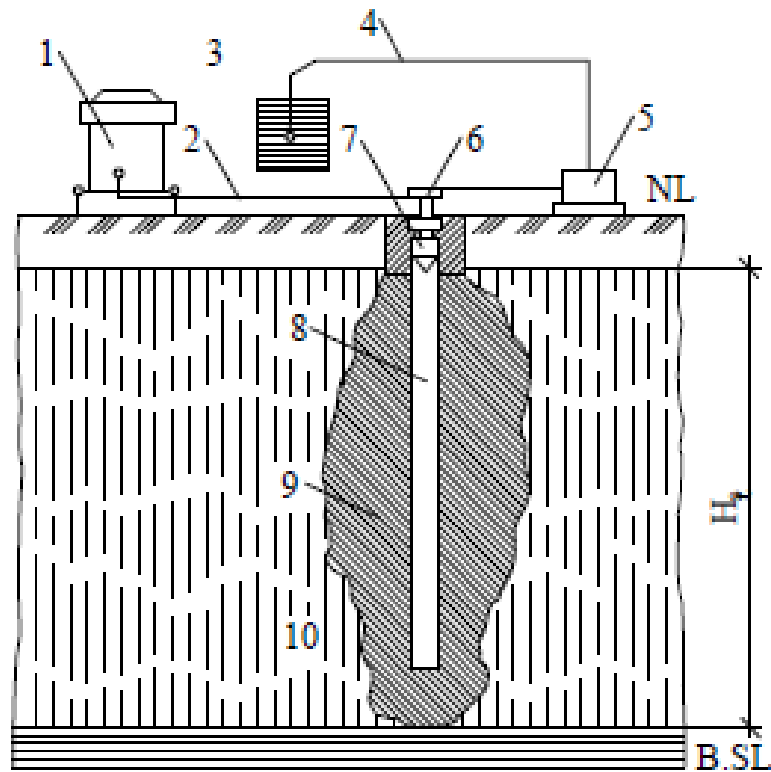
Схема термічного закріплення лесового ґрунту: 1 – компресор; 2 – трубопровід холодного повітря; 3 – місткість для пального; 4 – трубопровід для пального; 5 – насос для нагнітання пального; 6 – форсунка; 7 – камера згорання; 8 – свердловина; 9 – зона термічного випалення лесового ґрунту; 10 – лесовий ґрунт
